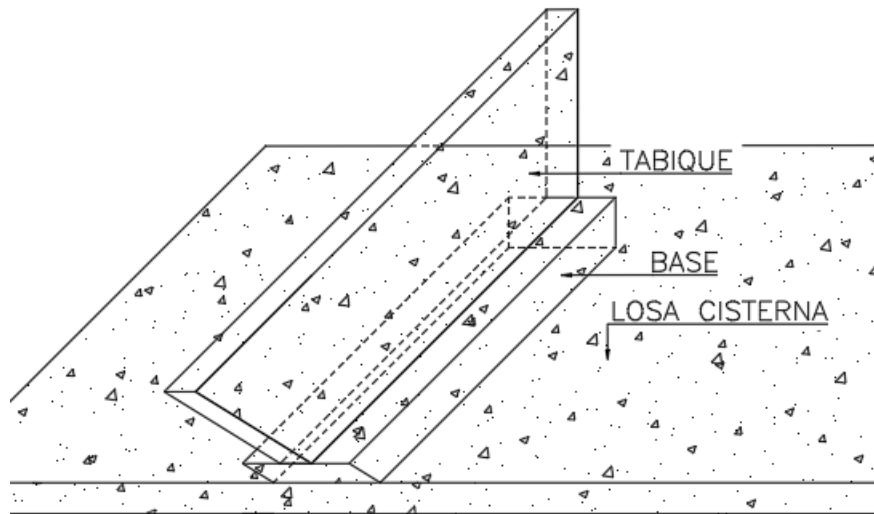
Esquema de los tabiques – Fuente de elaboración propia
